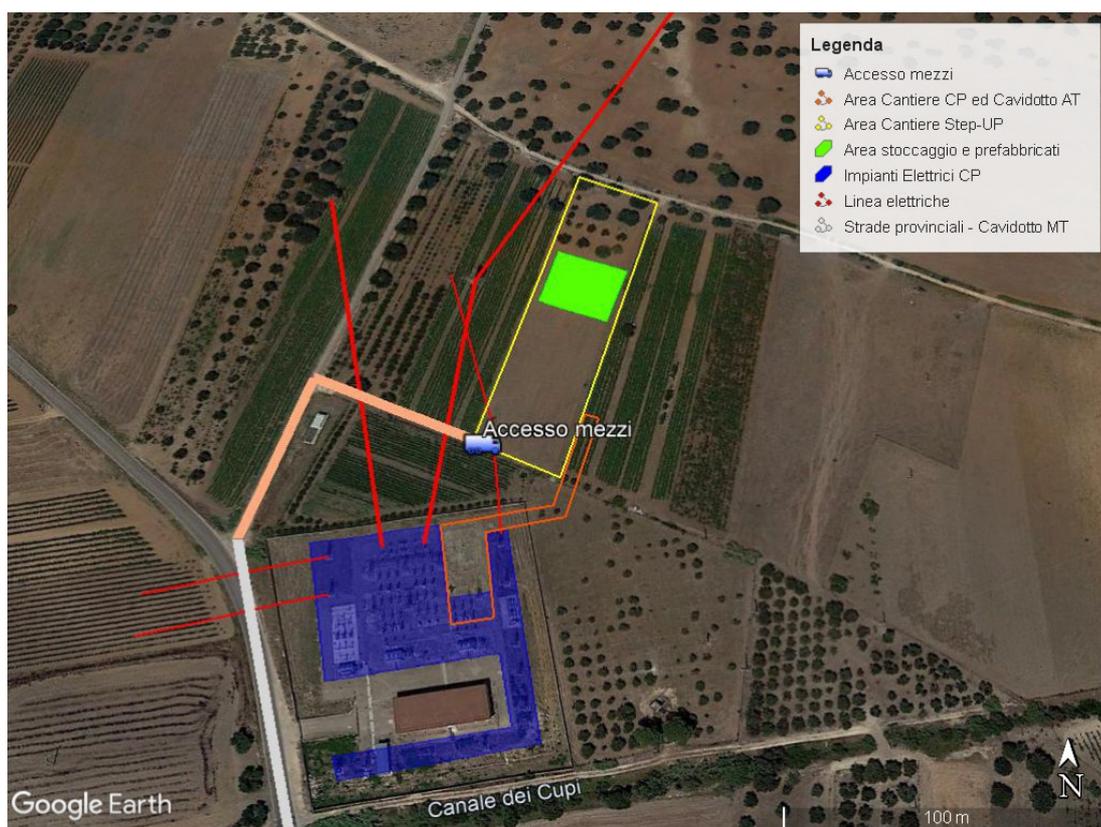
Aree di cantieri - Cavidotto MT e AT, Stazione di elevazione e Cabina Primaria
